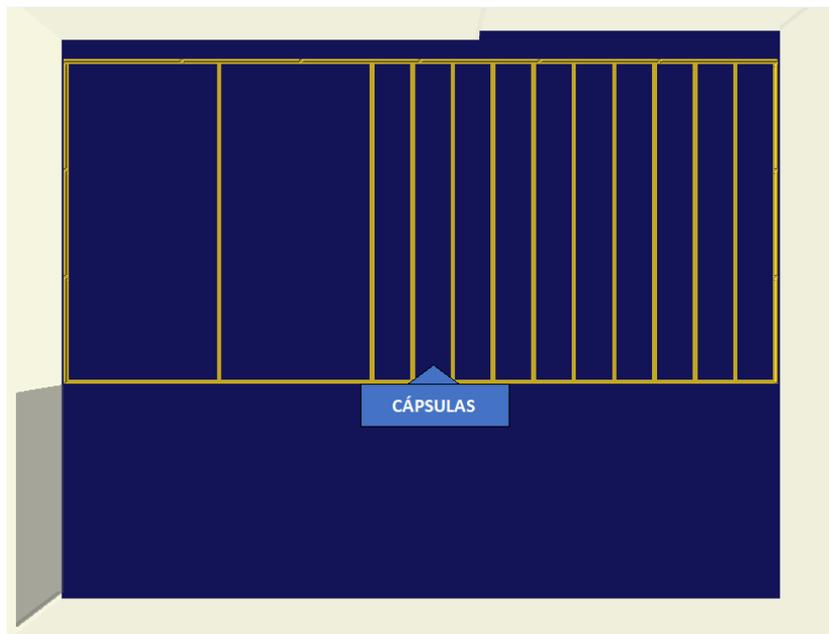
Planta do Armazém de Cápsulas (modelação em OpenSCAD)
